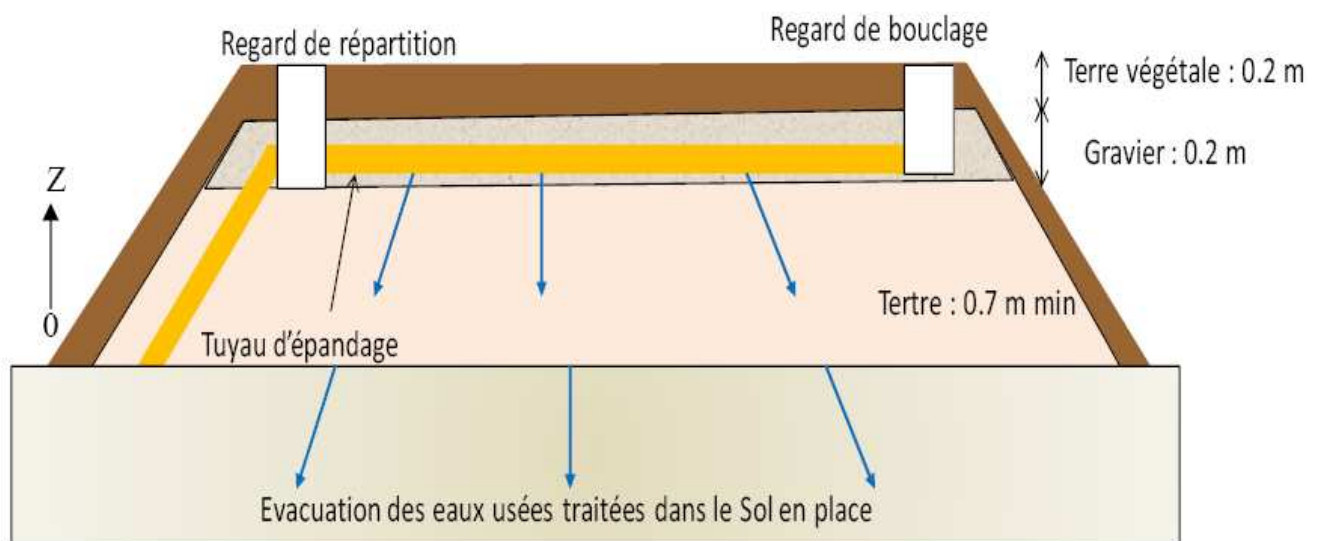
Coupe longitudinale de la filière terre d'infiltration.
